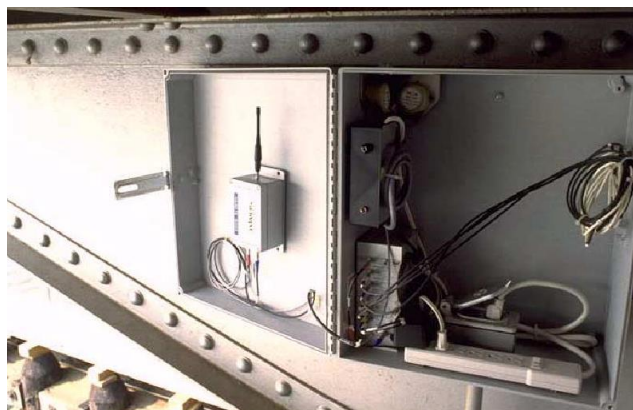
Sistema para monitoramento remoto da ponte metálica
